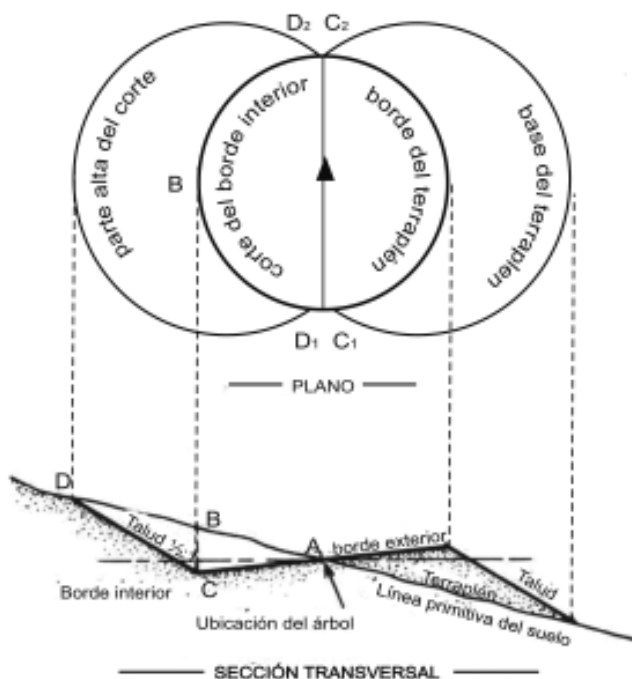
Sección transversal y vista del plano de una terraza individual (Suárez de Castro, 1980).
